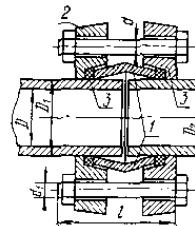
Соединение асбестоцементных труб чугунной болтовой муфтой:
